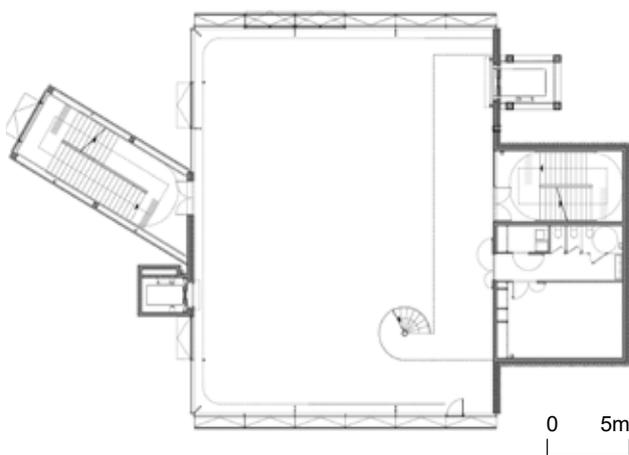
Le Dôme, Grundriss erstes Obergeschoss
